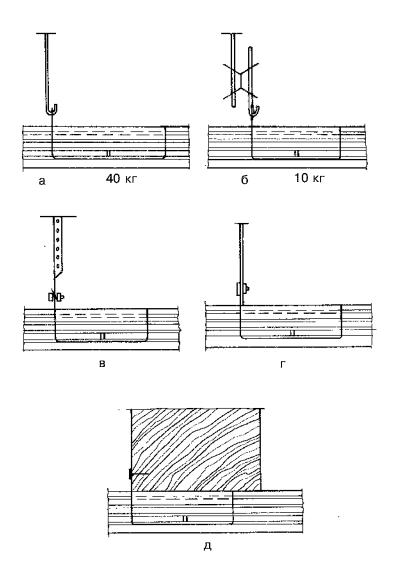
Подвесы, использующиеся для монтажа подвесных потолков с металлическим каркасом: а — прямой стержень б — сочлененный стержень; в — нониус; г — в виде полосы с прорезью;
